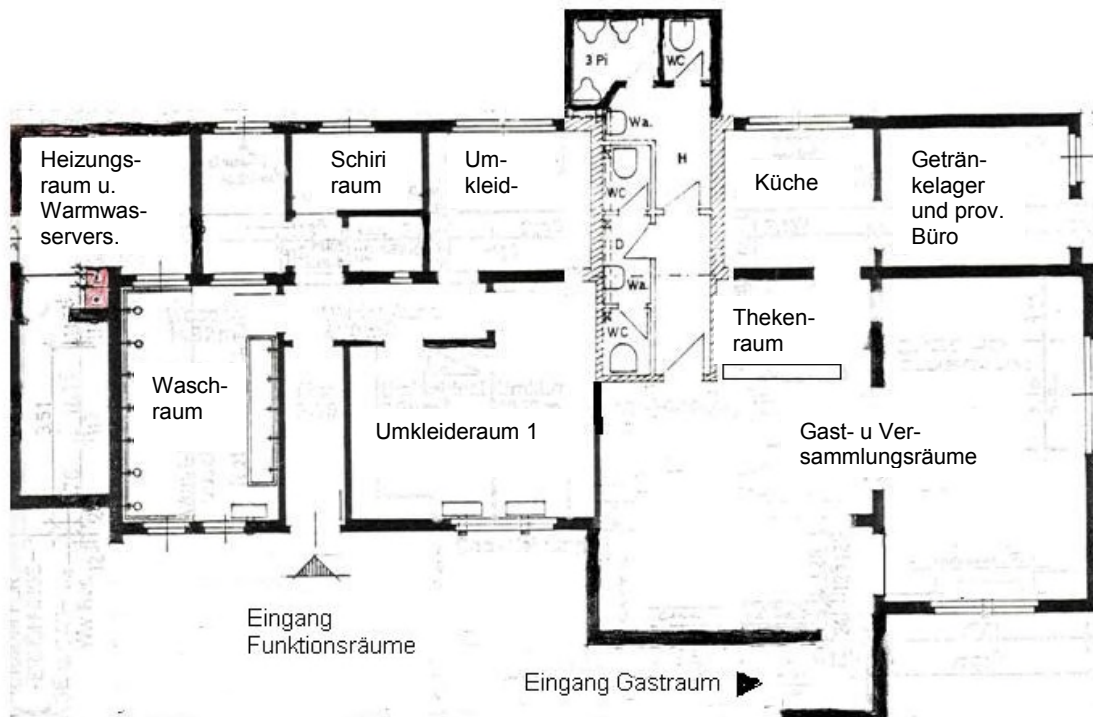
SJH - Grundriss Untergeschoss (Insgesamt 175 m<sup>2</sup>; Funktionsräume 106 m<sup>2</sup>, 69 m<sup>2</sup> Gasträume)
